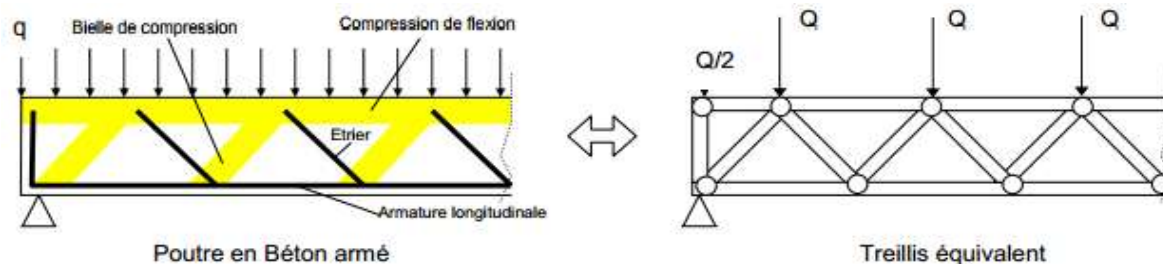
I.1 Fonctionnement d'une poutre en béton armé à celui d'une poutre fictive en treillis [7].
